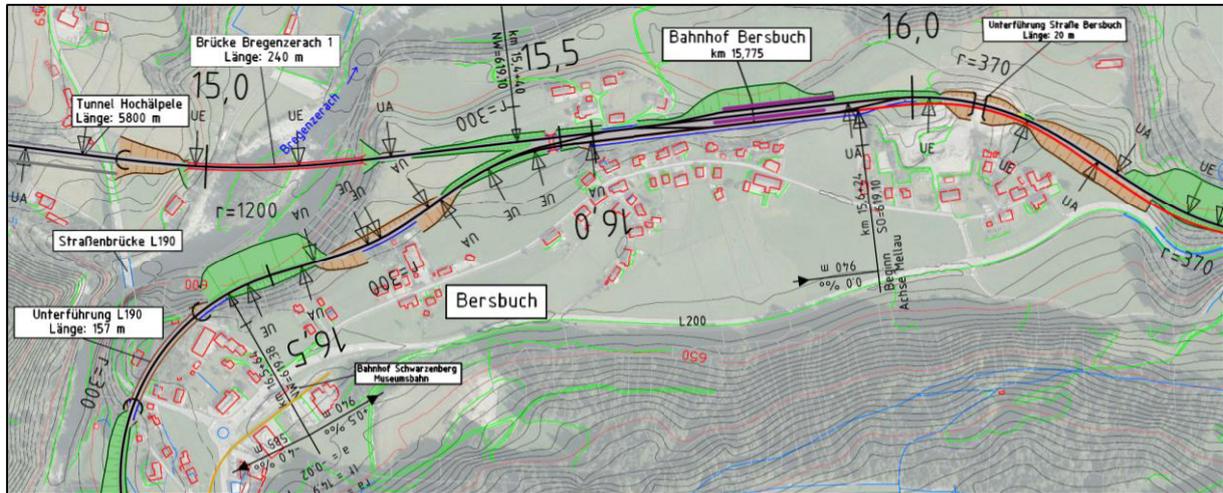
Detaillageplan Bahnhof Bersbuch
